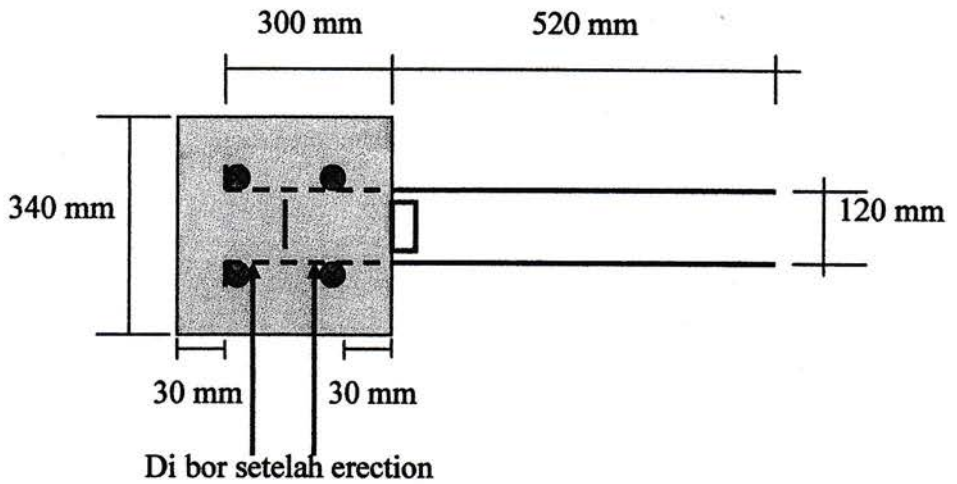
Sambungan antara kolom dengan balok yang telah di grouting, dan telah mengeras.
